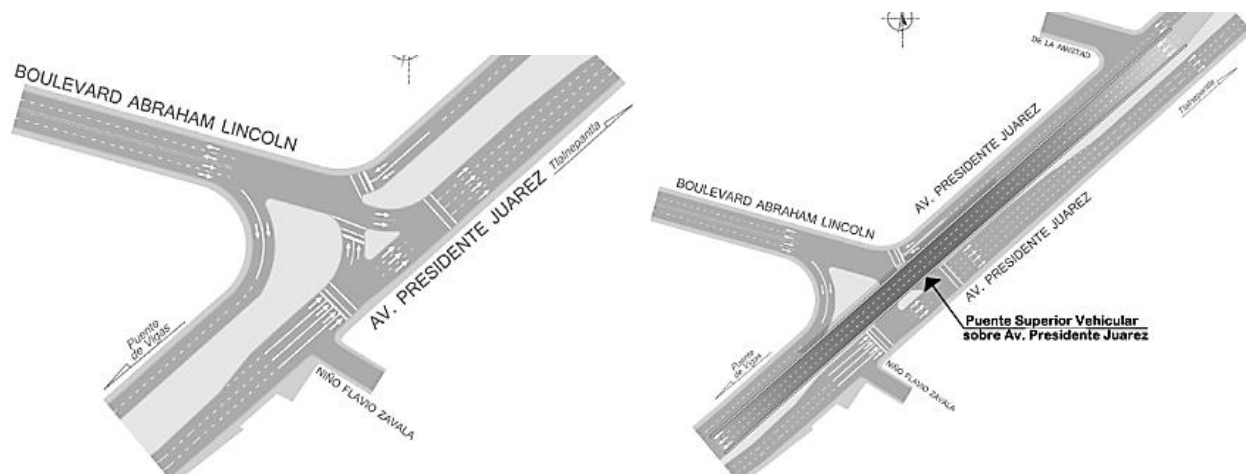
Vista en planta de adecuaciones por implementación de proyecto.
